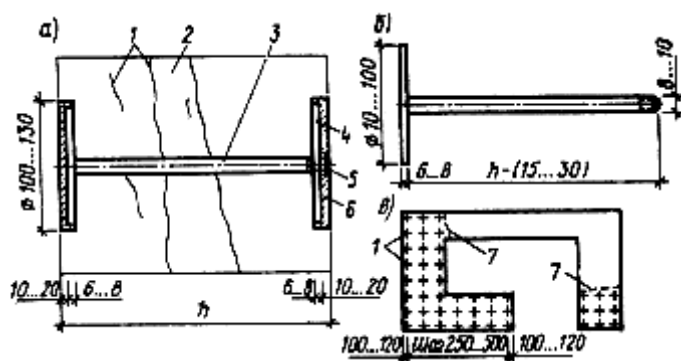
Реконструкция панелей с глубокими расслоениями с помощью болтов: а - деталь скрепления болтом; б - болт; в - схема расположения болтов при расслоении панели; 1 - трещины и расслоения; 2 - бетон; 3 - болт М8; 5 - гайка; 6 - легкий бетон или поризованный раствор; 7 - граница расслоения; h - толщина панели.
